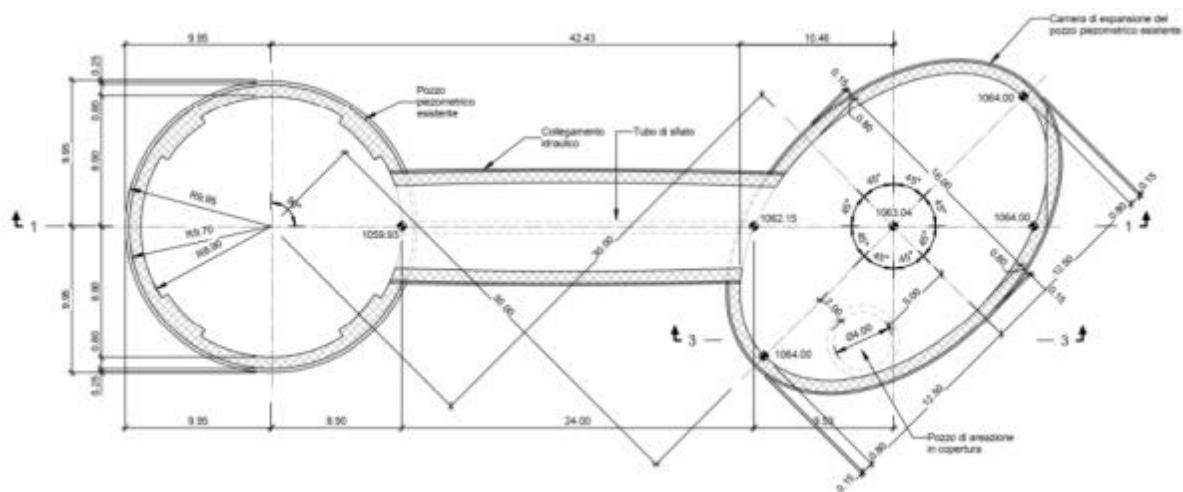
Nuova camera di espansione al pozzo piezometrico sulla derivazione Provvidenza – pianta
